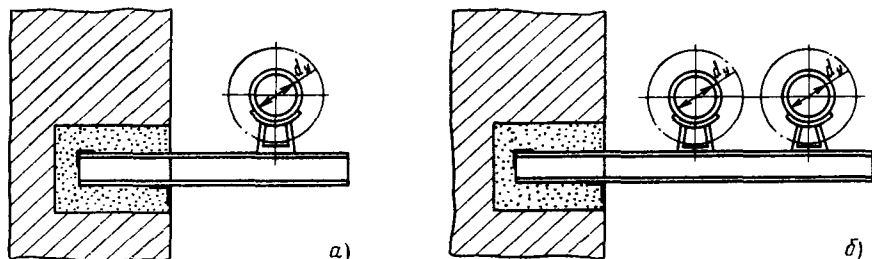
Прокладка трубопроводов на кронштейнах:
